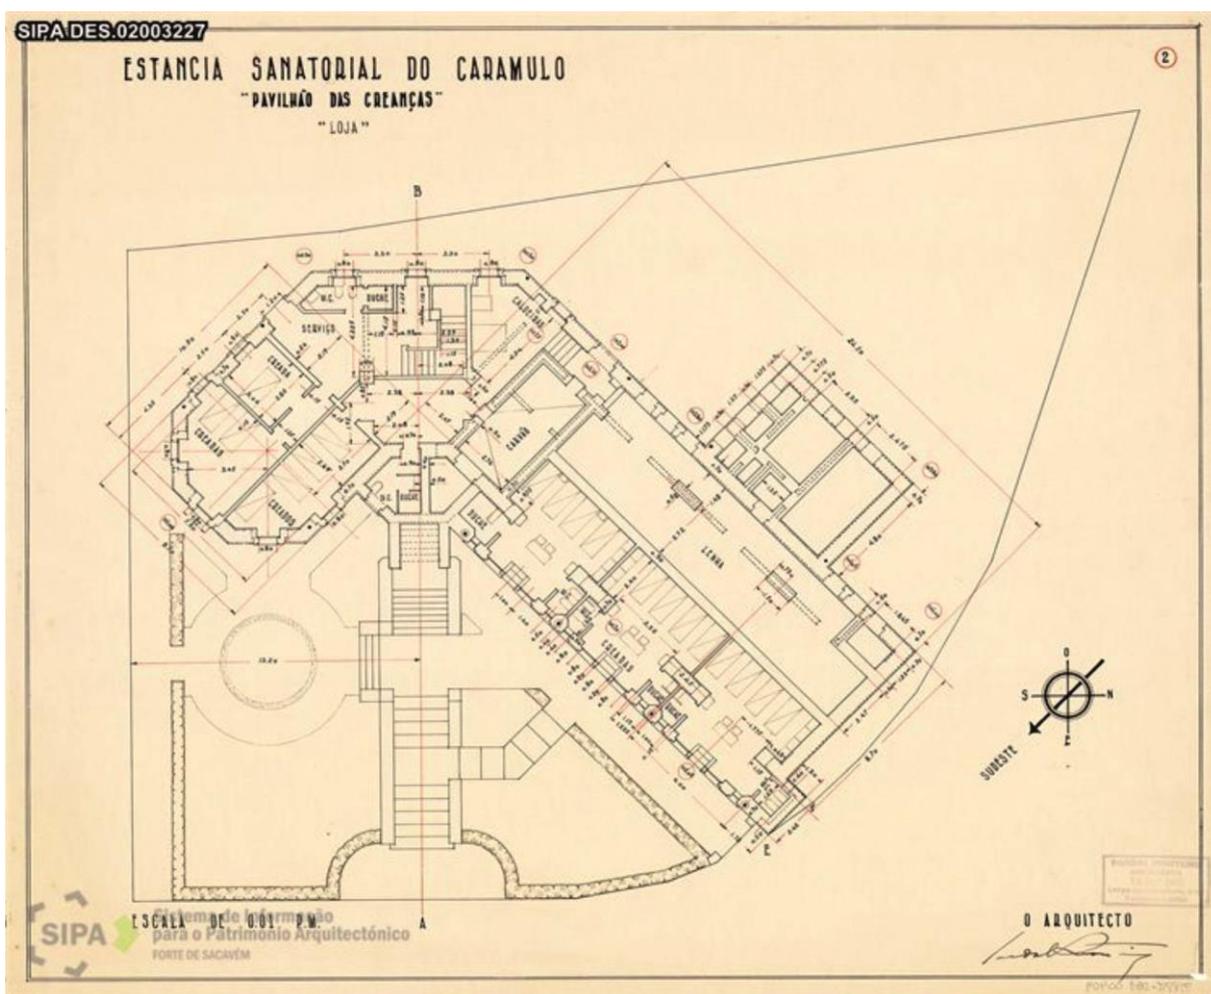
Planta do rés-do-chão – projeto de Pardal Monteiro
